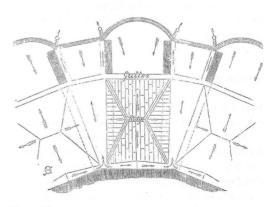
Toledo. Catedral, detalle de disposición de cubiertas en la girola (Street 1926)
